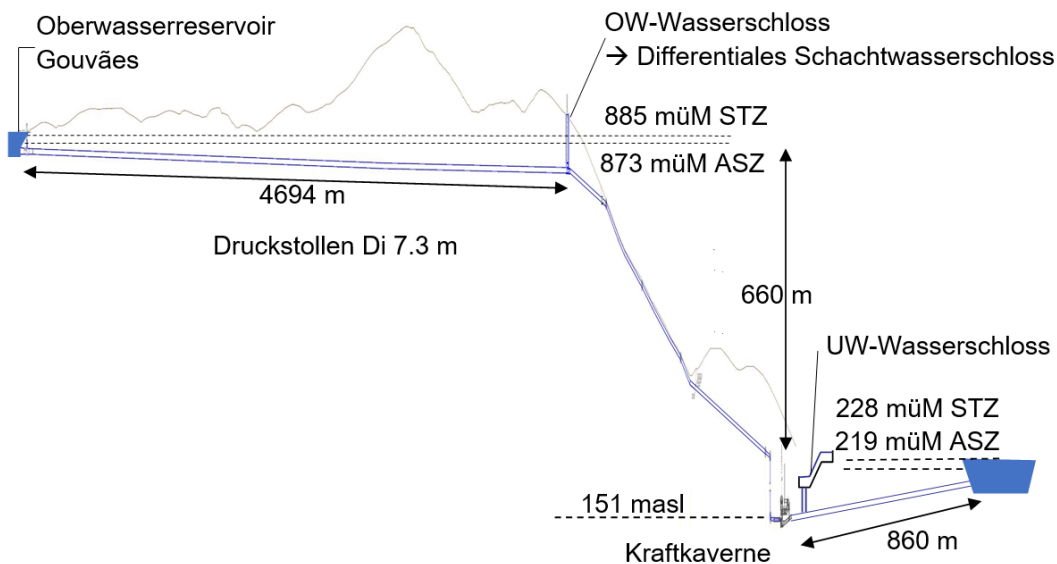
Längenschnitt Oberwassersystem PSKW Gouvães
